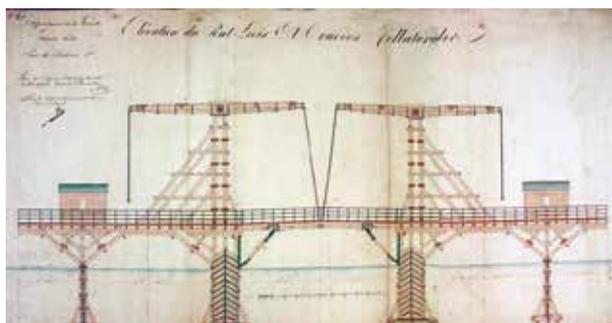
Élévation du pont-levis et travées collatérales, pont de Bordeaux proposé par l'ingénieur en chef du corps impérial des Ponts et Chaussées Didier, 1809 (A.D.Gir., 2 Fi 2731).
